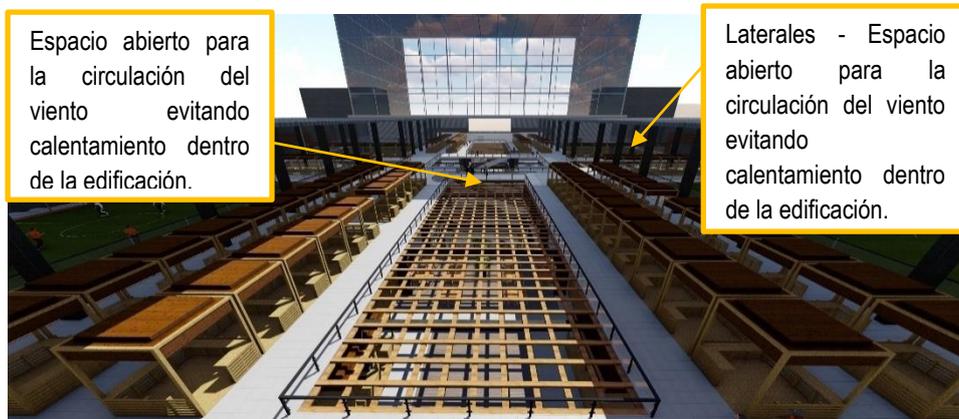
Plaza central Propuesta Arquitectónica 3D.
